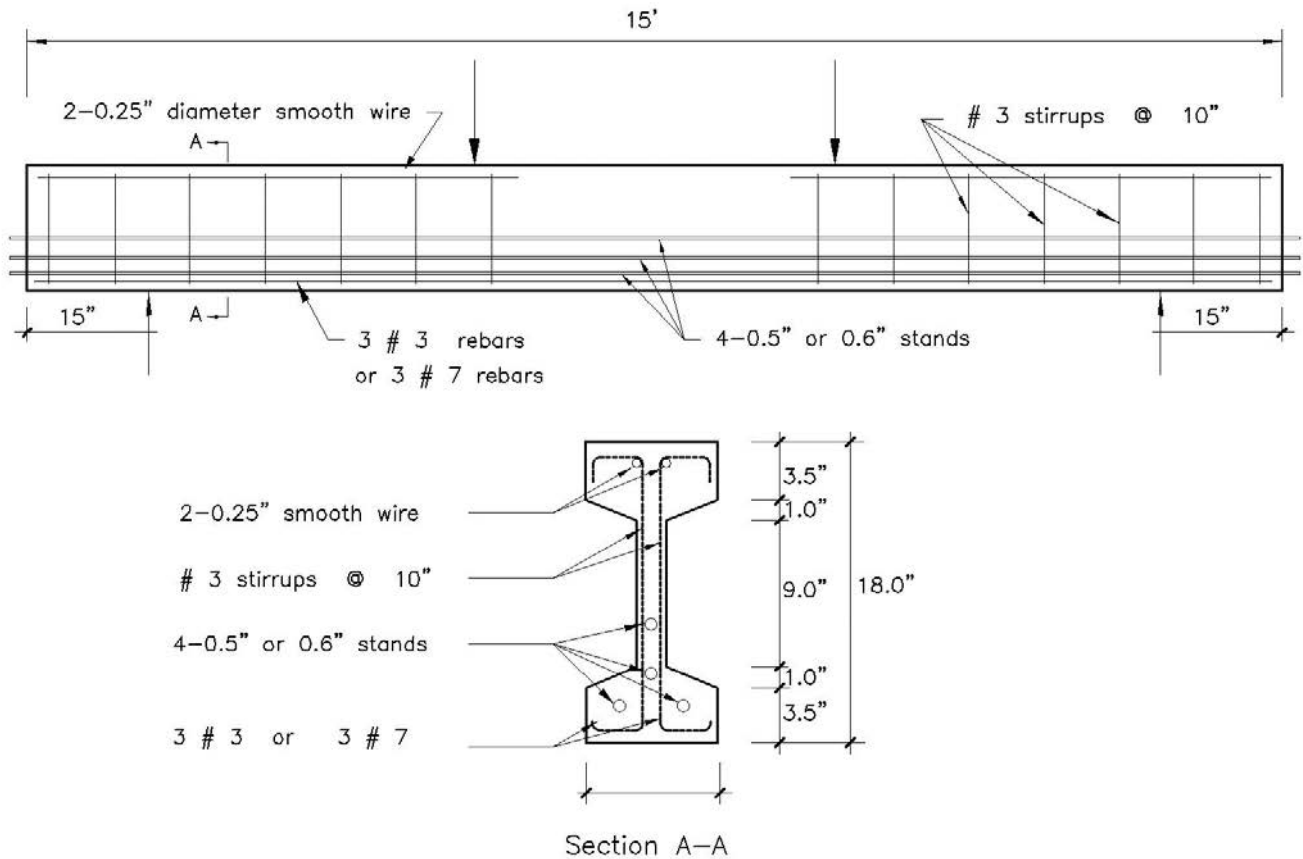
Viga de hormigón pretensado con armadura a cortante ensayada por Elzanaty et al. [18].
